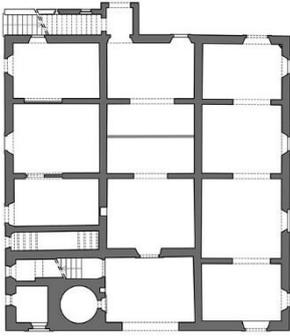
Pianta del PT allo stato di fatto, dopo le demolizioni del 2013. [rielaborazione dell'autrice, estratto Tav. 2]
